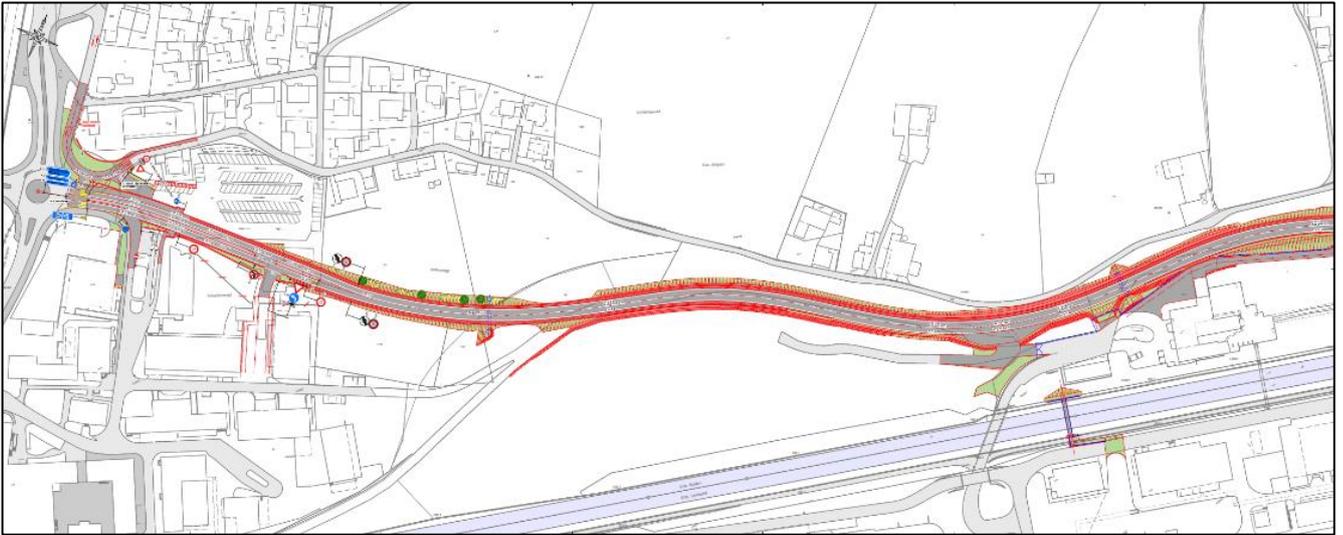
Ausschnitt Plan Signalisation und Markierung, Abschnitt 1, Situation 1:500, Auflageprojekt West-Ost-Verbindung (07.05.2018), Amt für Tiefbau
